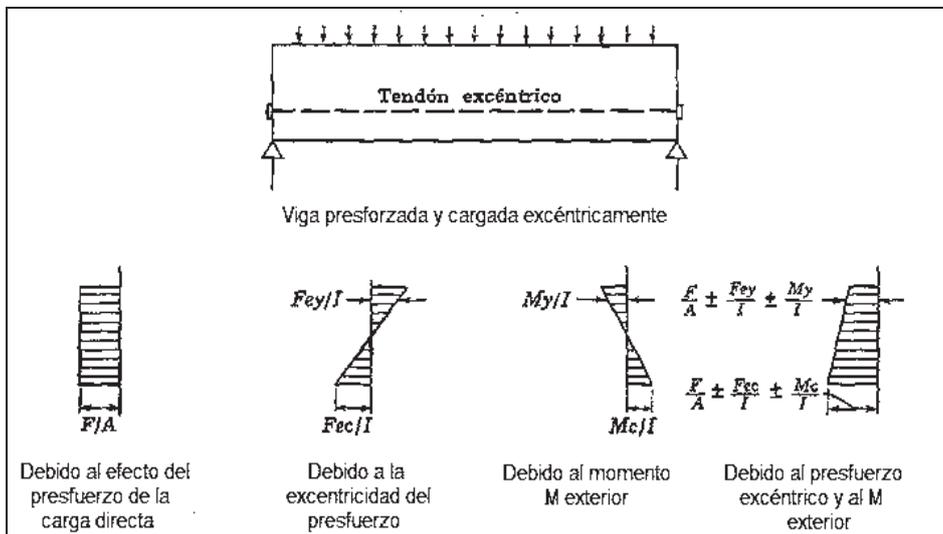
Distribución del esfuerzo a través de una sección de concreto presforzado excéntricamente [2].
